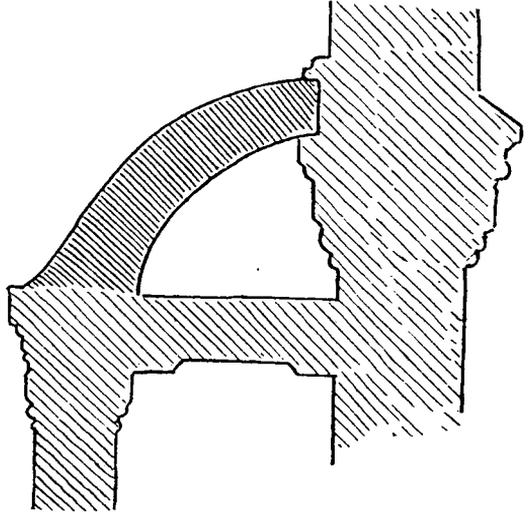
COUPE DE LA TOITURE D'UNE VÉRANDA.
